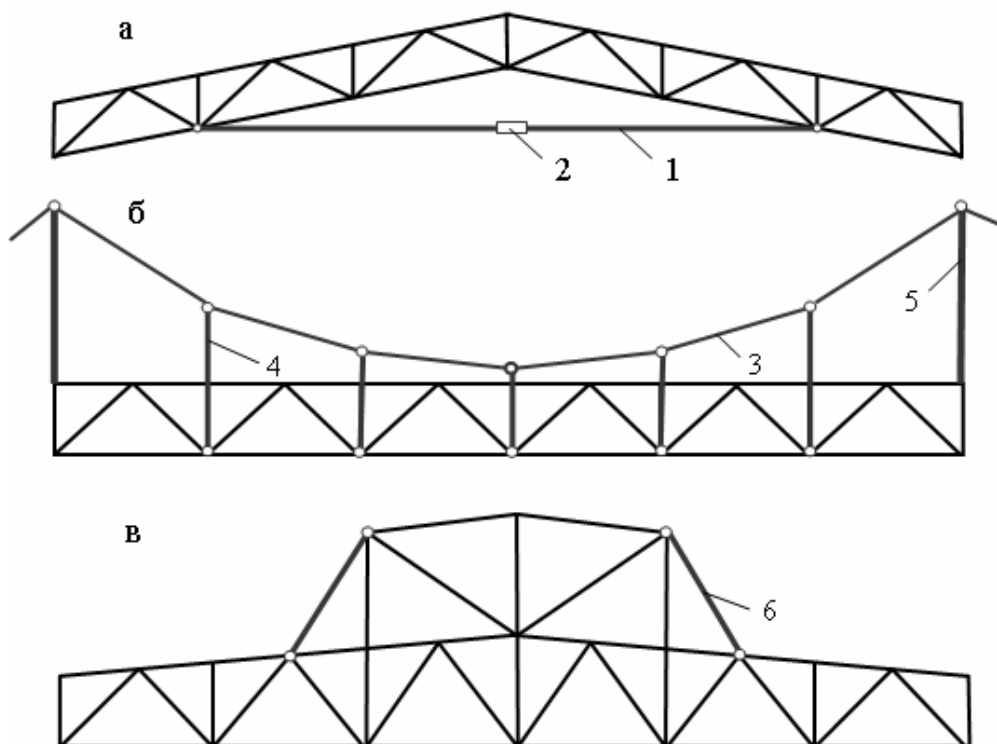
Схемы усиления стропильных ферм: *а* – предварительно напряженными затяжками, *б* – шарнирно-стержневыми цепями, *в* – включением конструкции фонаря в совместную работу с фермой: 1 – затяжка, 2 – натяжное приспособление, 3 – стальной канат, 4 – подвеска, 5 – дополнительная стойка, 6 – дополнительный раскос
